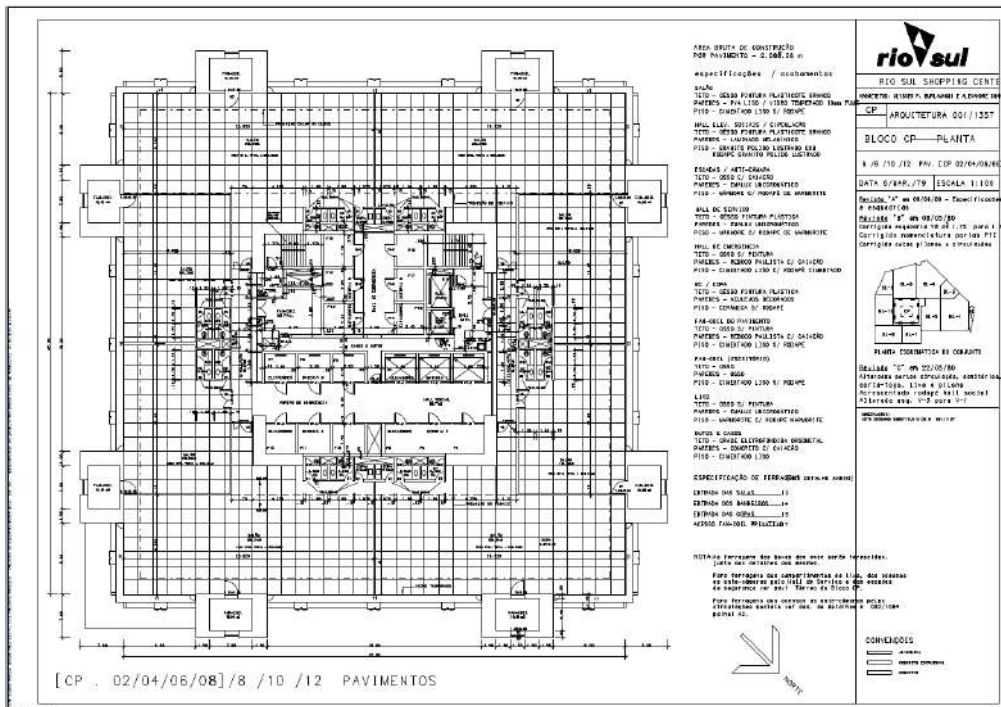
Torre Rio Sul. Planta do 6°, 8°, 10°, 12° Pavimentos, com treliça na fachada.
